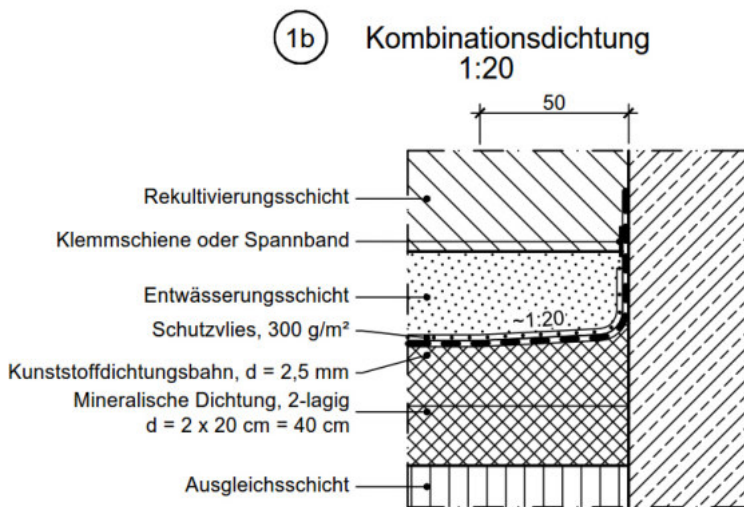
Detail Anschluss Kombinationsabdichtung an Betonbauwerk
